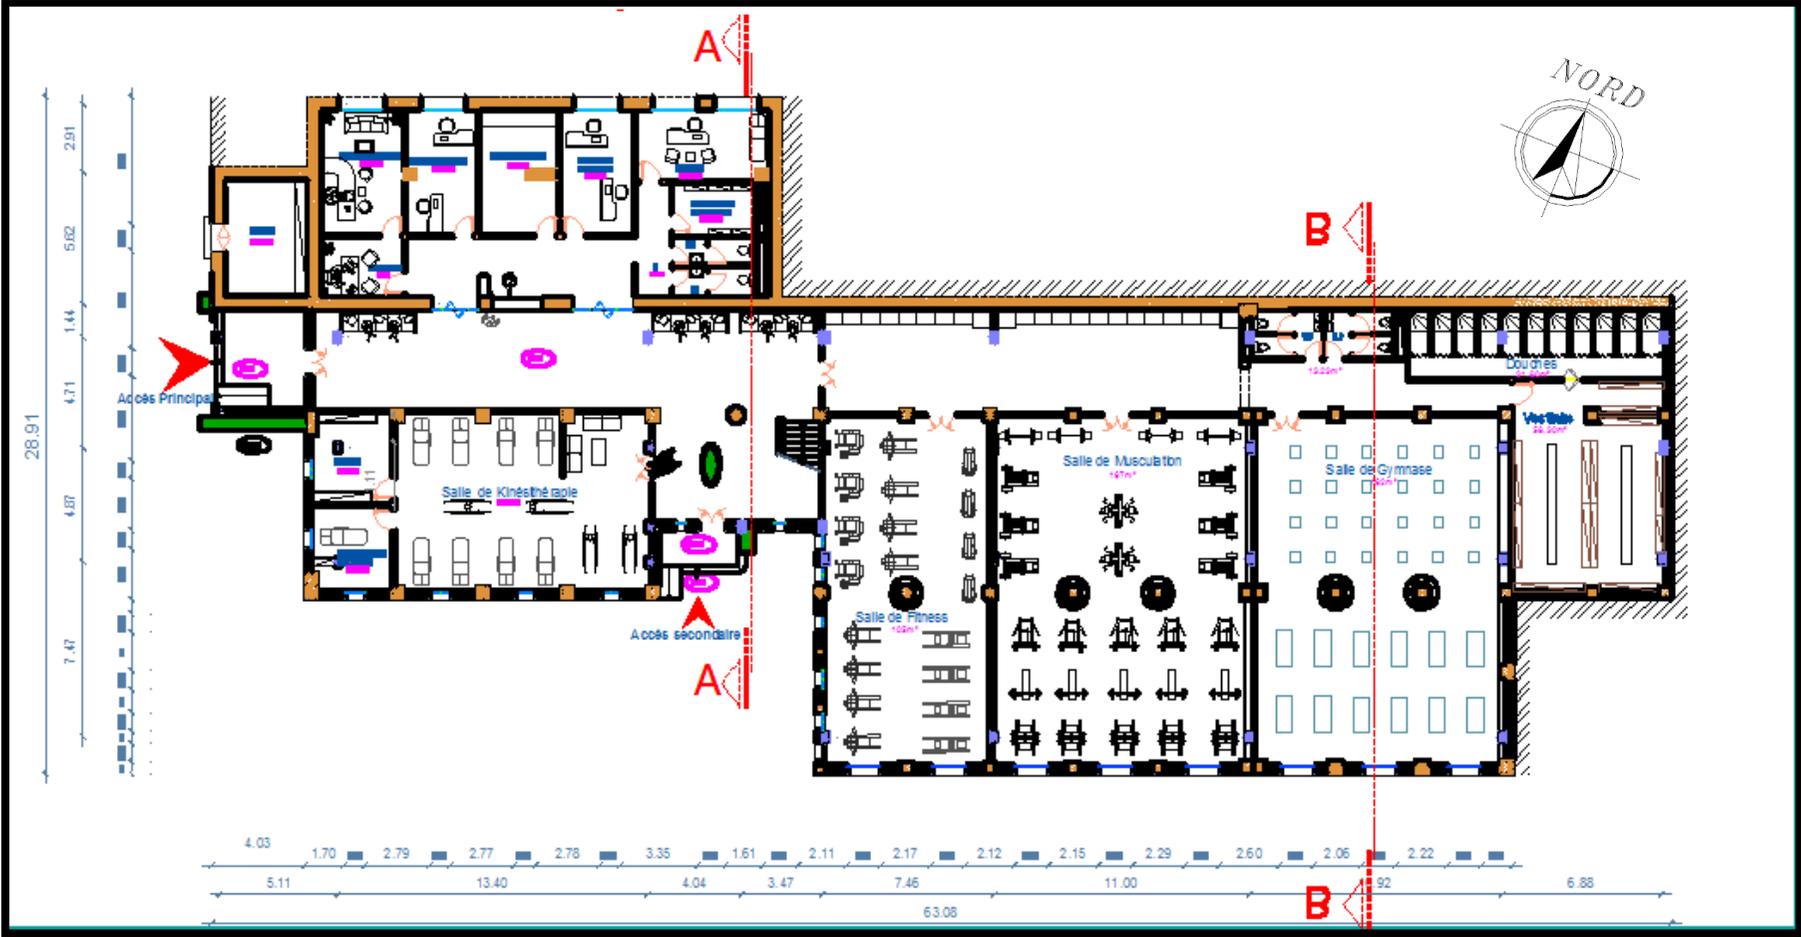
plan architectural de RDC (+0,34) de centre sportif
